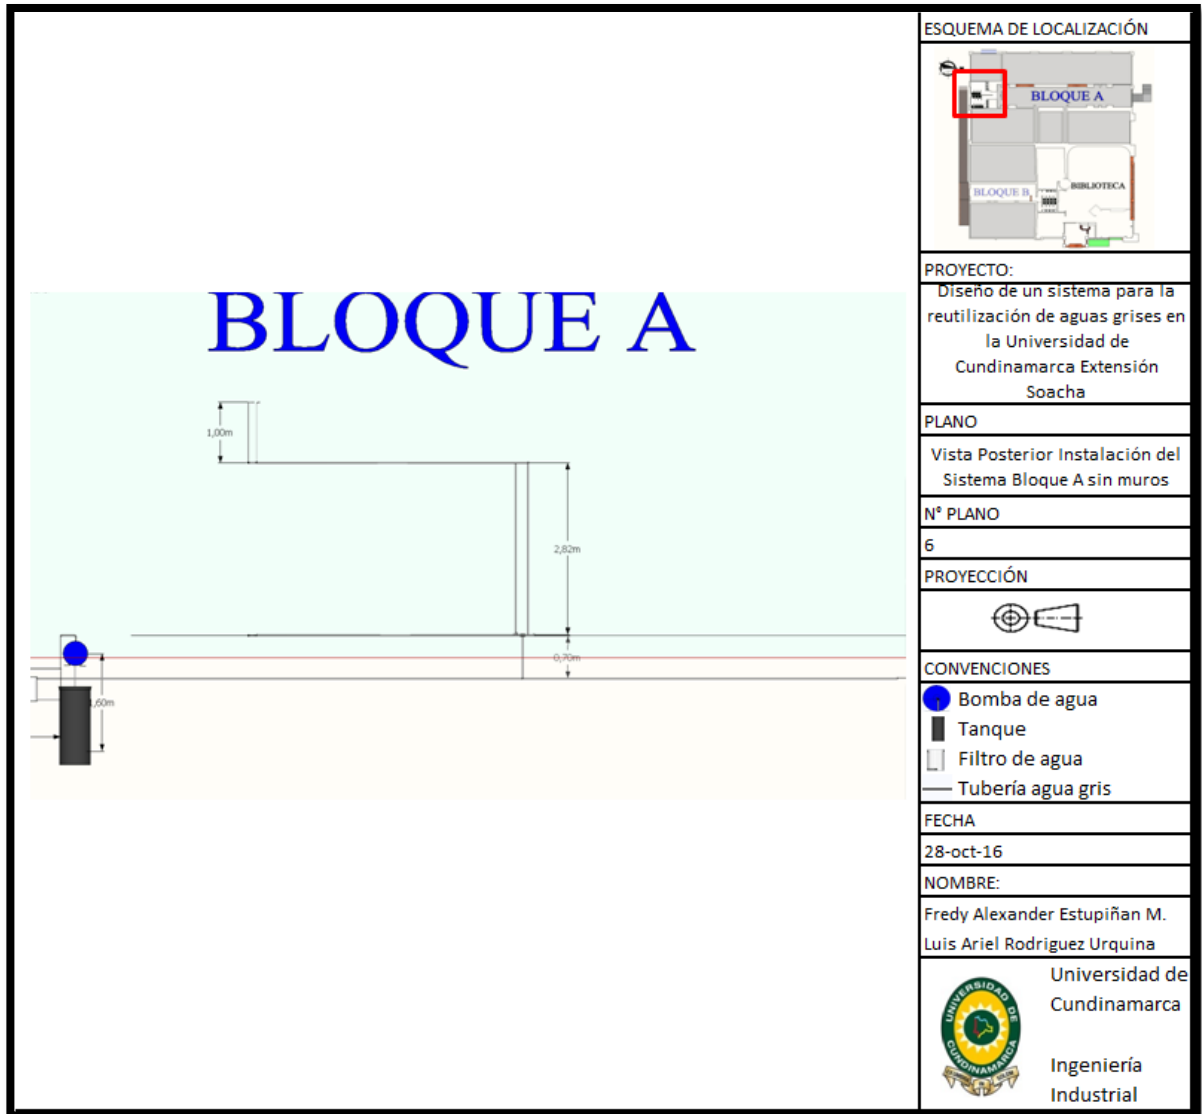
Vista Posterior Instalación del Sistema Bloque A sin paredes
